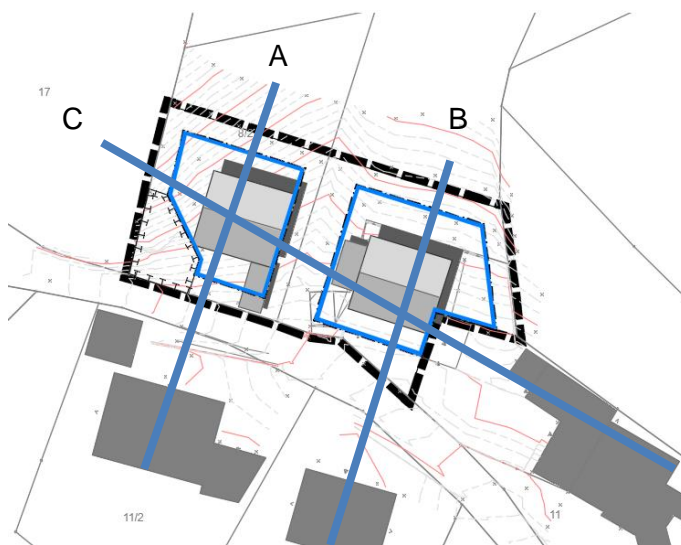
Lageplan einer möglichen Bebauung mit den Schnittlinien für die folgenden Schnitte (Quelle: eigene Darstellung)
